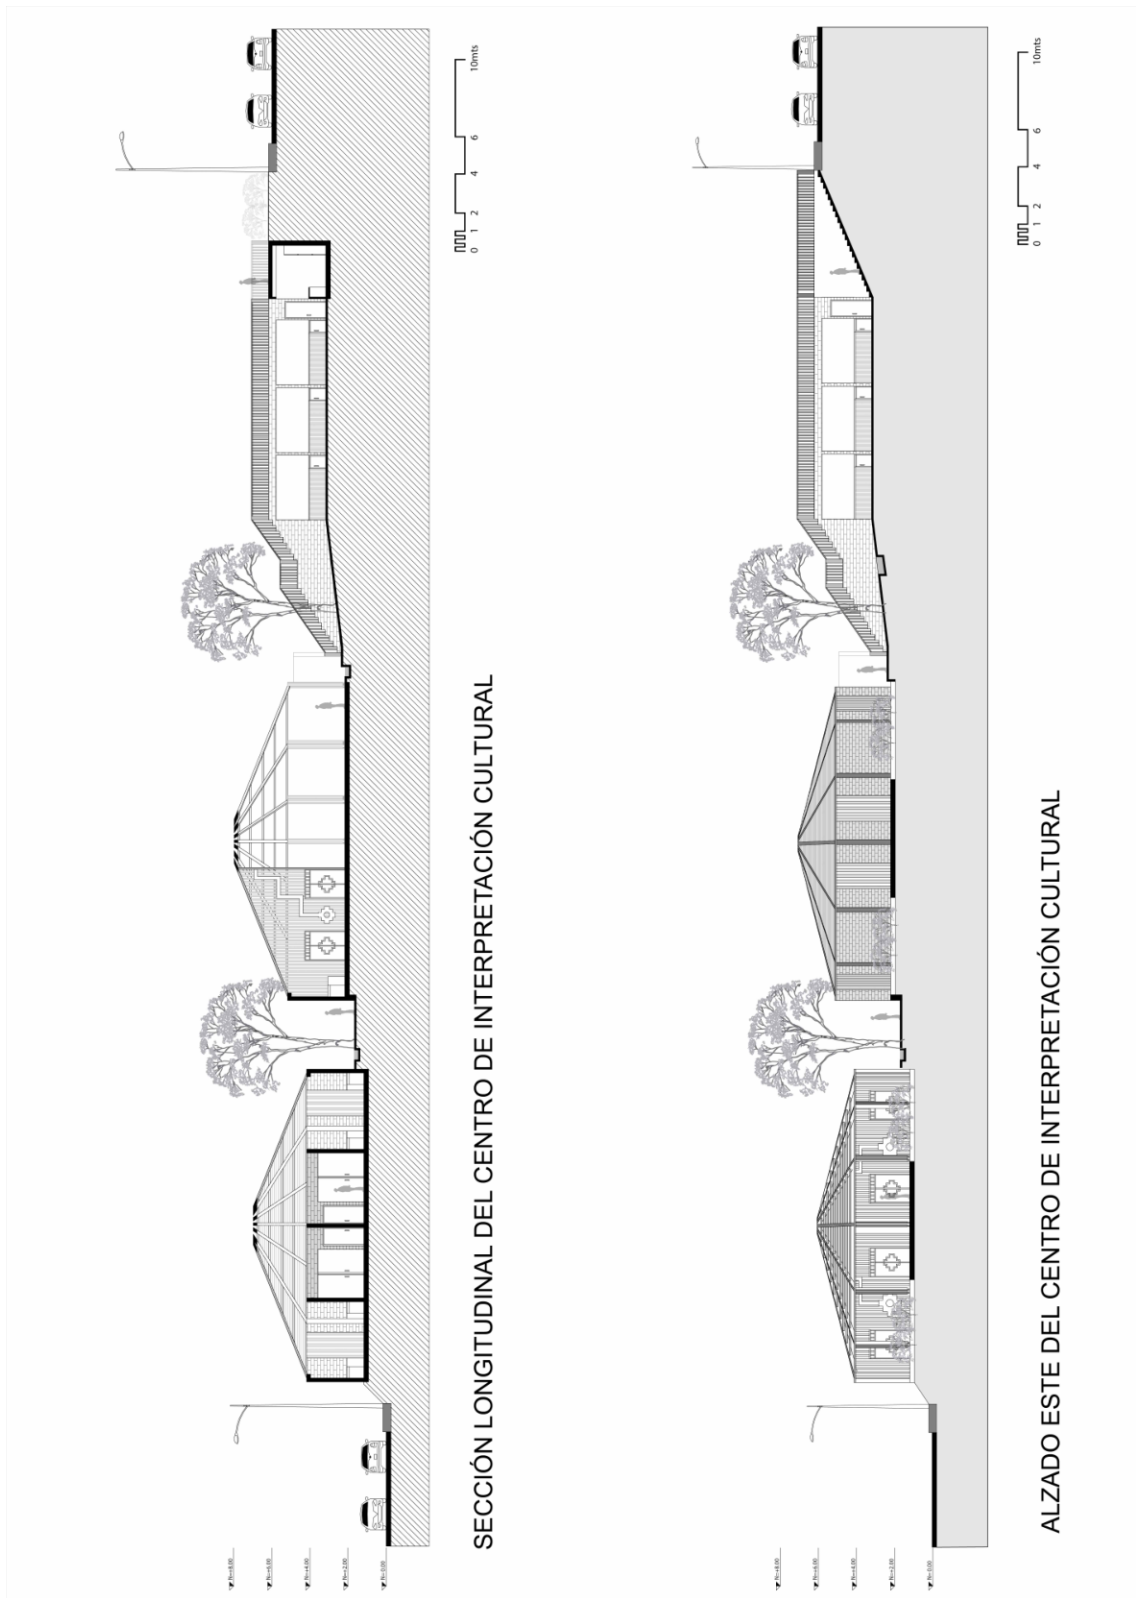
Sección longitudinal y alzado del proyecto
